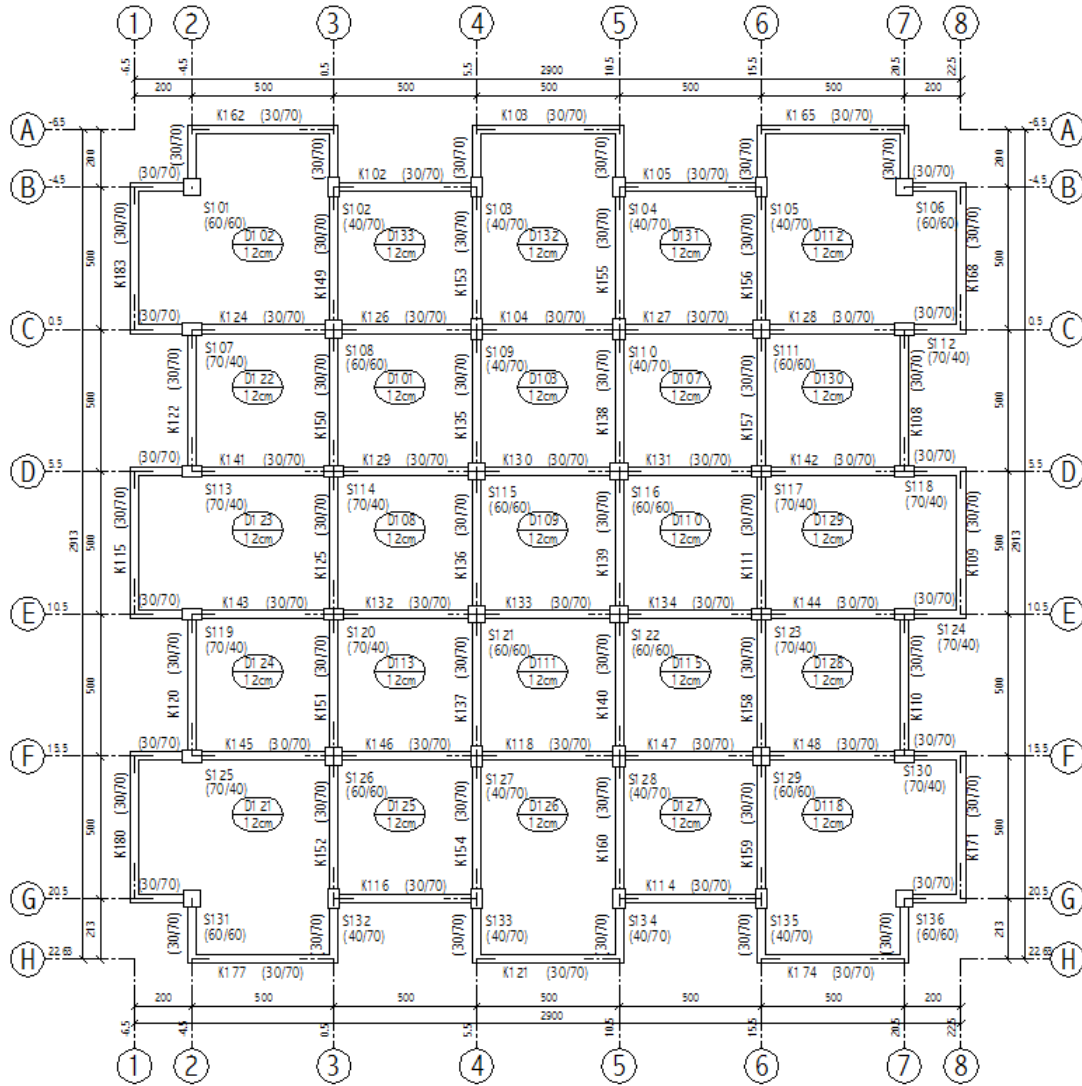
Bina B 10 katlı kirişli plan bilgisi
